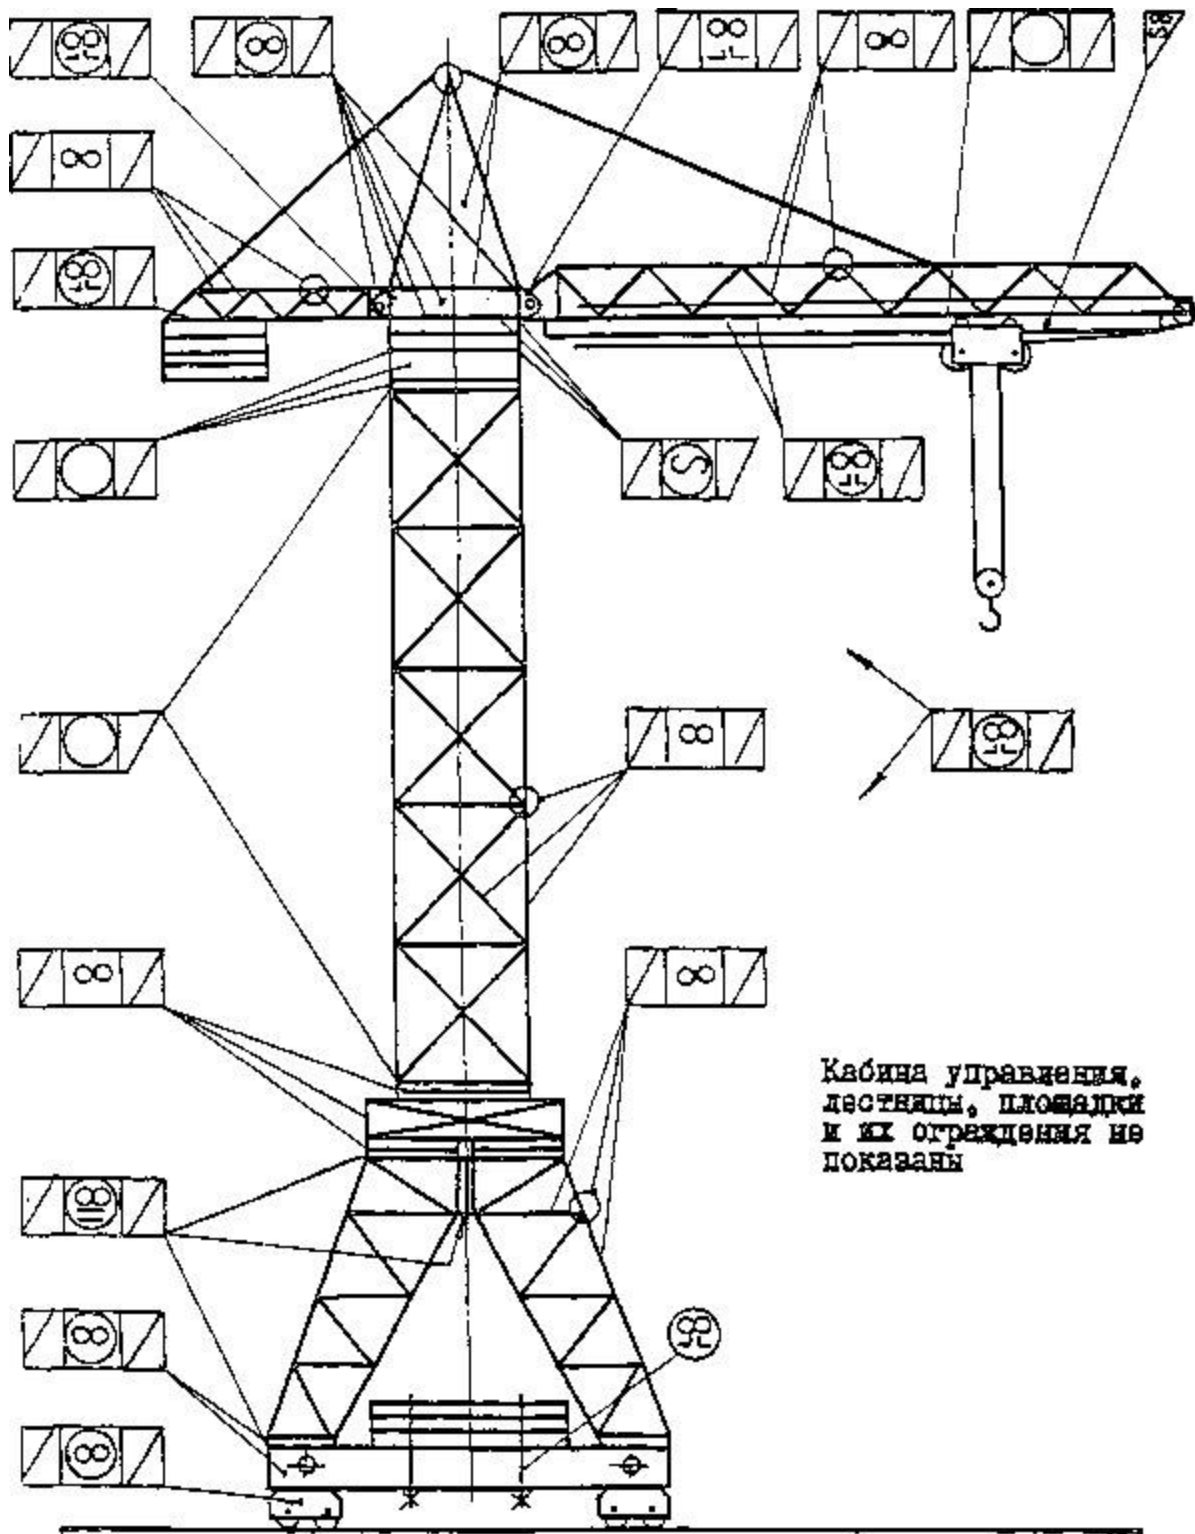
Схема к карте осмотра металлоконструкций строительного башенного крана с неповоротной решетчатой башней, жестко закрепленной на ходовой раме в виде портала, и балочной стрелой
